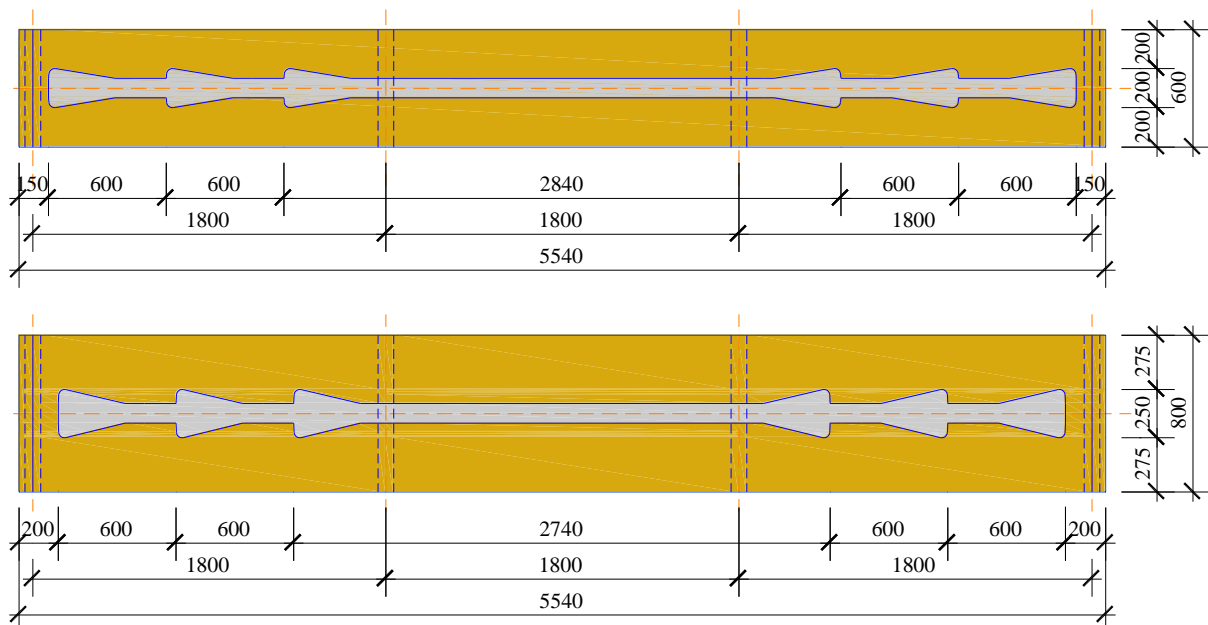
Grundriss der Prüfkörpergeometrie für Biegeprüfungen mit tropfenförmiger Ausbildung der in das Brettsperrholzelement eingefrästen Schubkonsolen [4]
